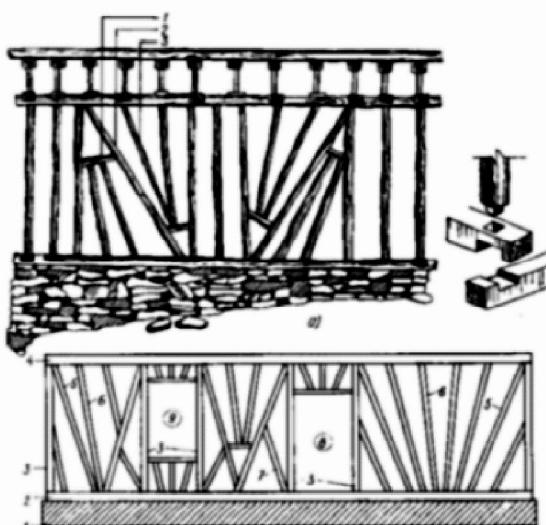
Схемы расположения деревянных каркасов (синч): а – монолитный стеновой каркас: 1 – промежуточный прогон; 2 - раскос; 3 - промежуточный раскос; б – элемента синча с оконными и дверными проемами: 1 - фундамент; 2 - нижний прогон; 3-стойки; 4-верхний прогон (сарров); 5-раскосы; 6-каркасы; 7-подкос (кашак); 8 - дверной проём; 9 - оконный проем.
